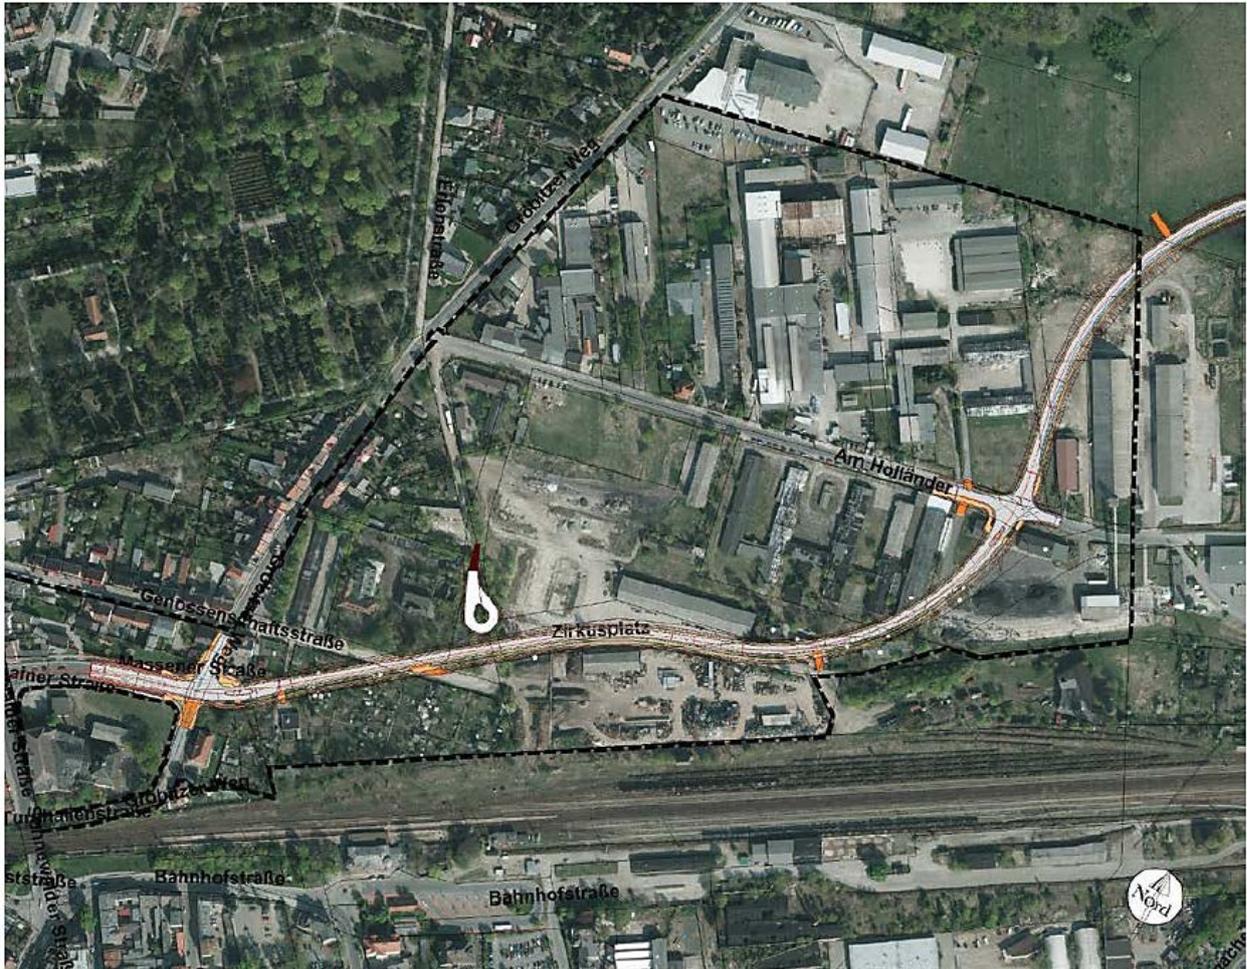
Übersichtslageplan Luftbild mit planfestgestellter B 96
